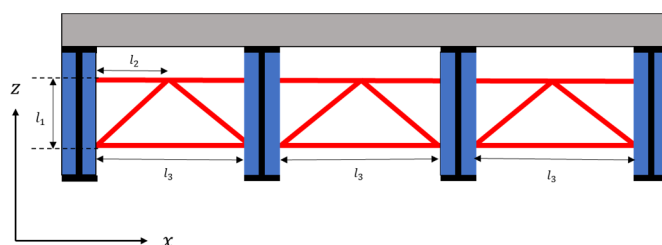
詳細橋梁モデルの概要図[(x, z)平面]
